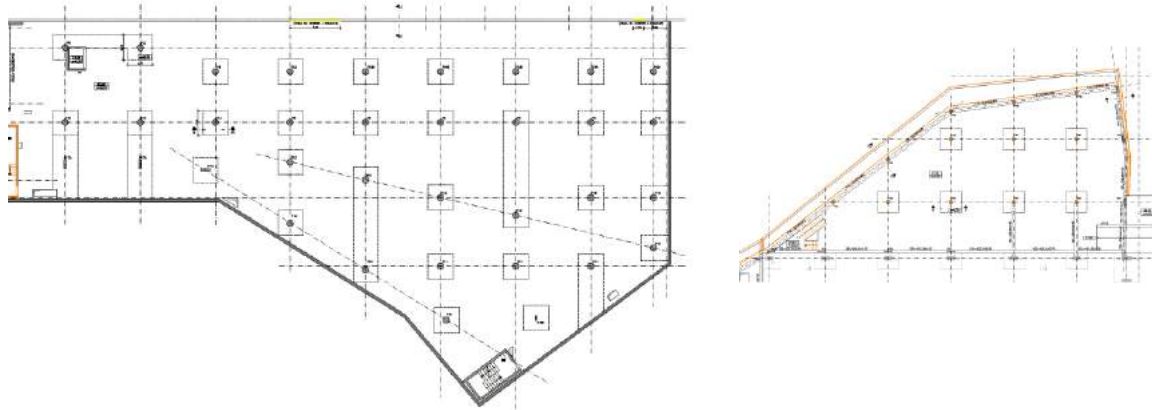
Planta do Piso -5 (Vigas do auditório) e faseamento do tensionamento dos cabos.
